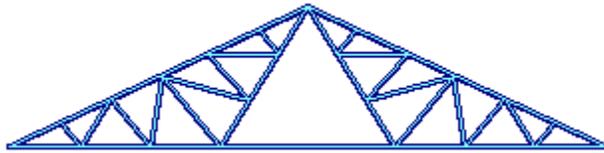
Armadura Fink, 12 Paneles, Abanico.
